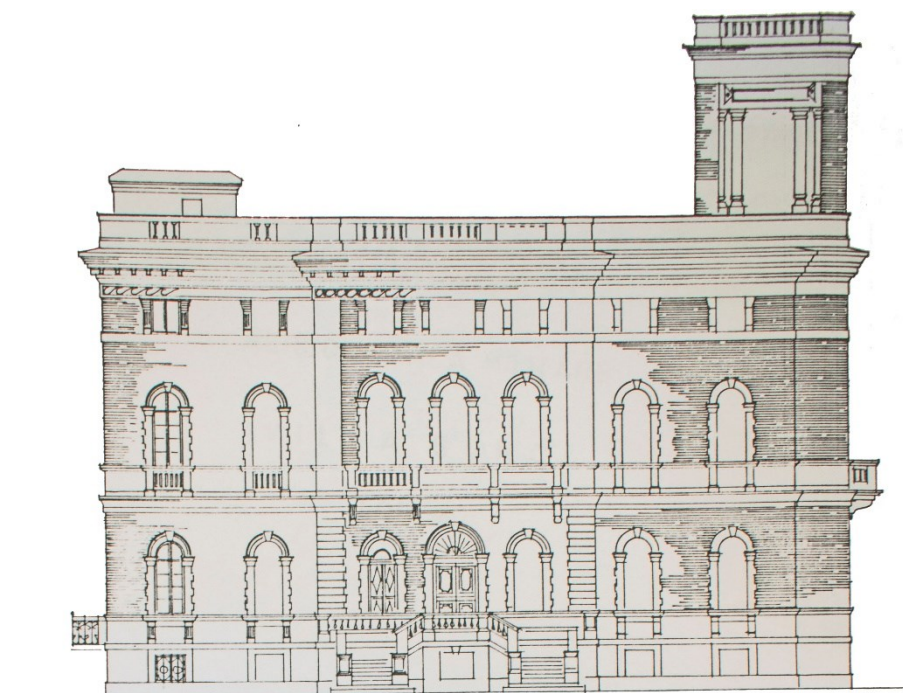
Prospetto Nord, 1986 (Archivio Ce.Fo.Av.En.)
